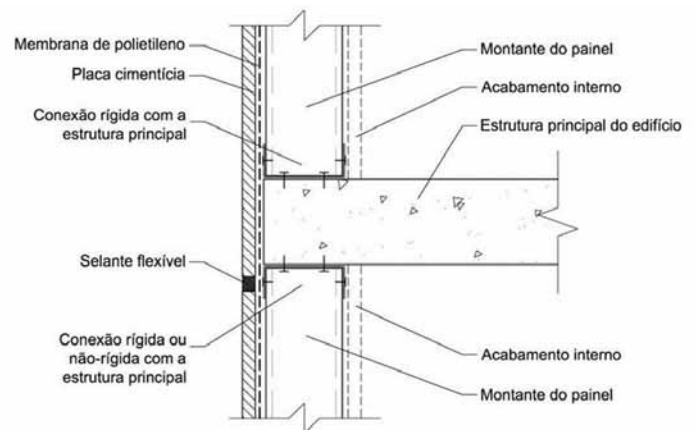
Junta horizontal flexível em placas cimentícias – montagem embutida / Fonte: Adaptado de SANTIAGO, 2008
